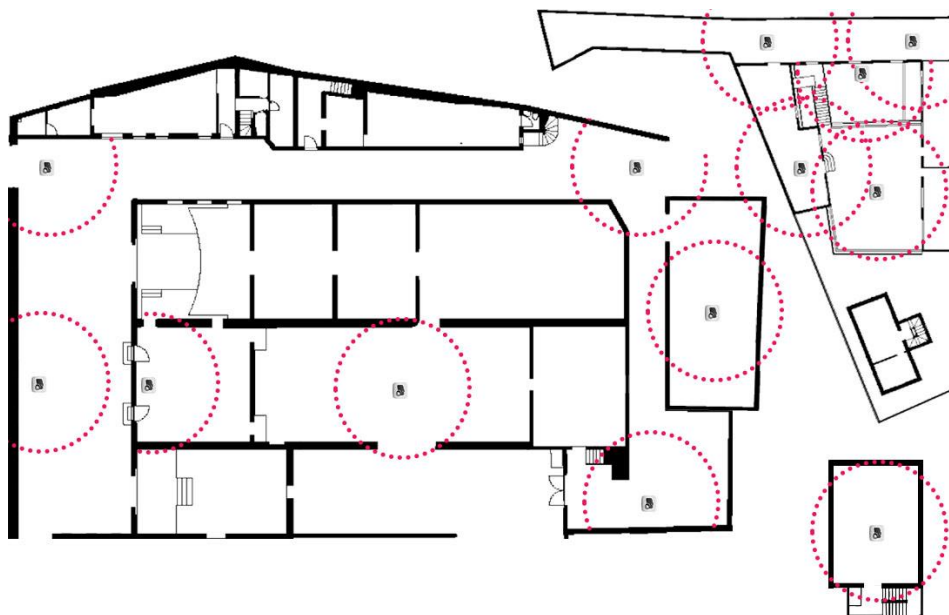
Ilustração da planta final do protótipo (horizontal)
